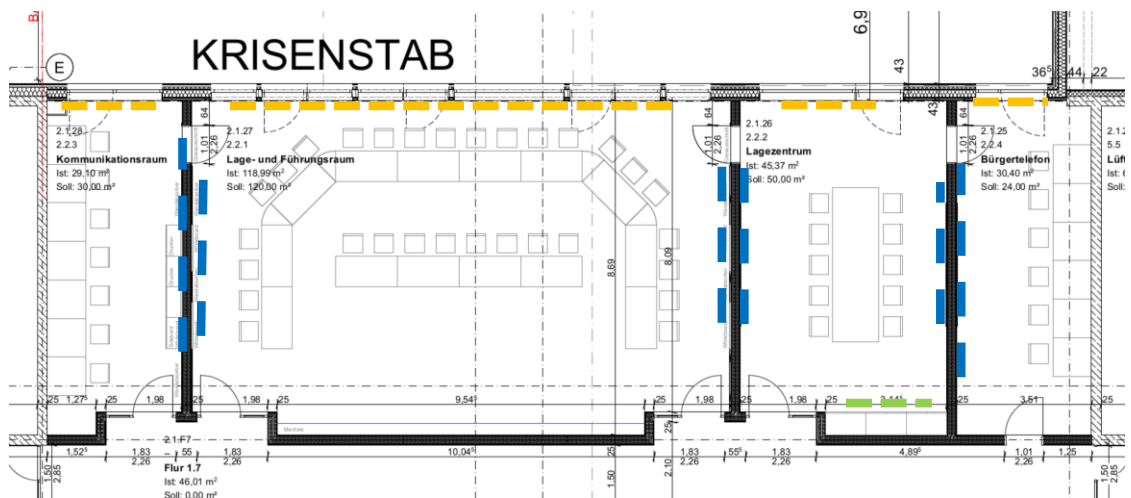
Grundriss Räume Krisenstab mit Wandabsorbern (blau gestrichelt) bzw. Vorhänge (orange gestrichelt) oder schallabsorbierende Möbelfronten (grün)
